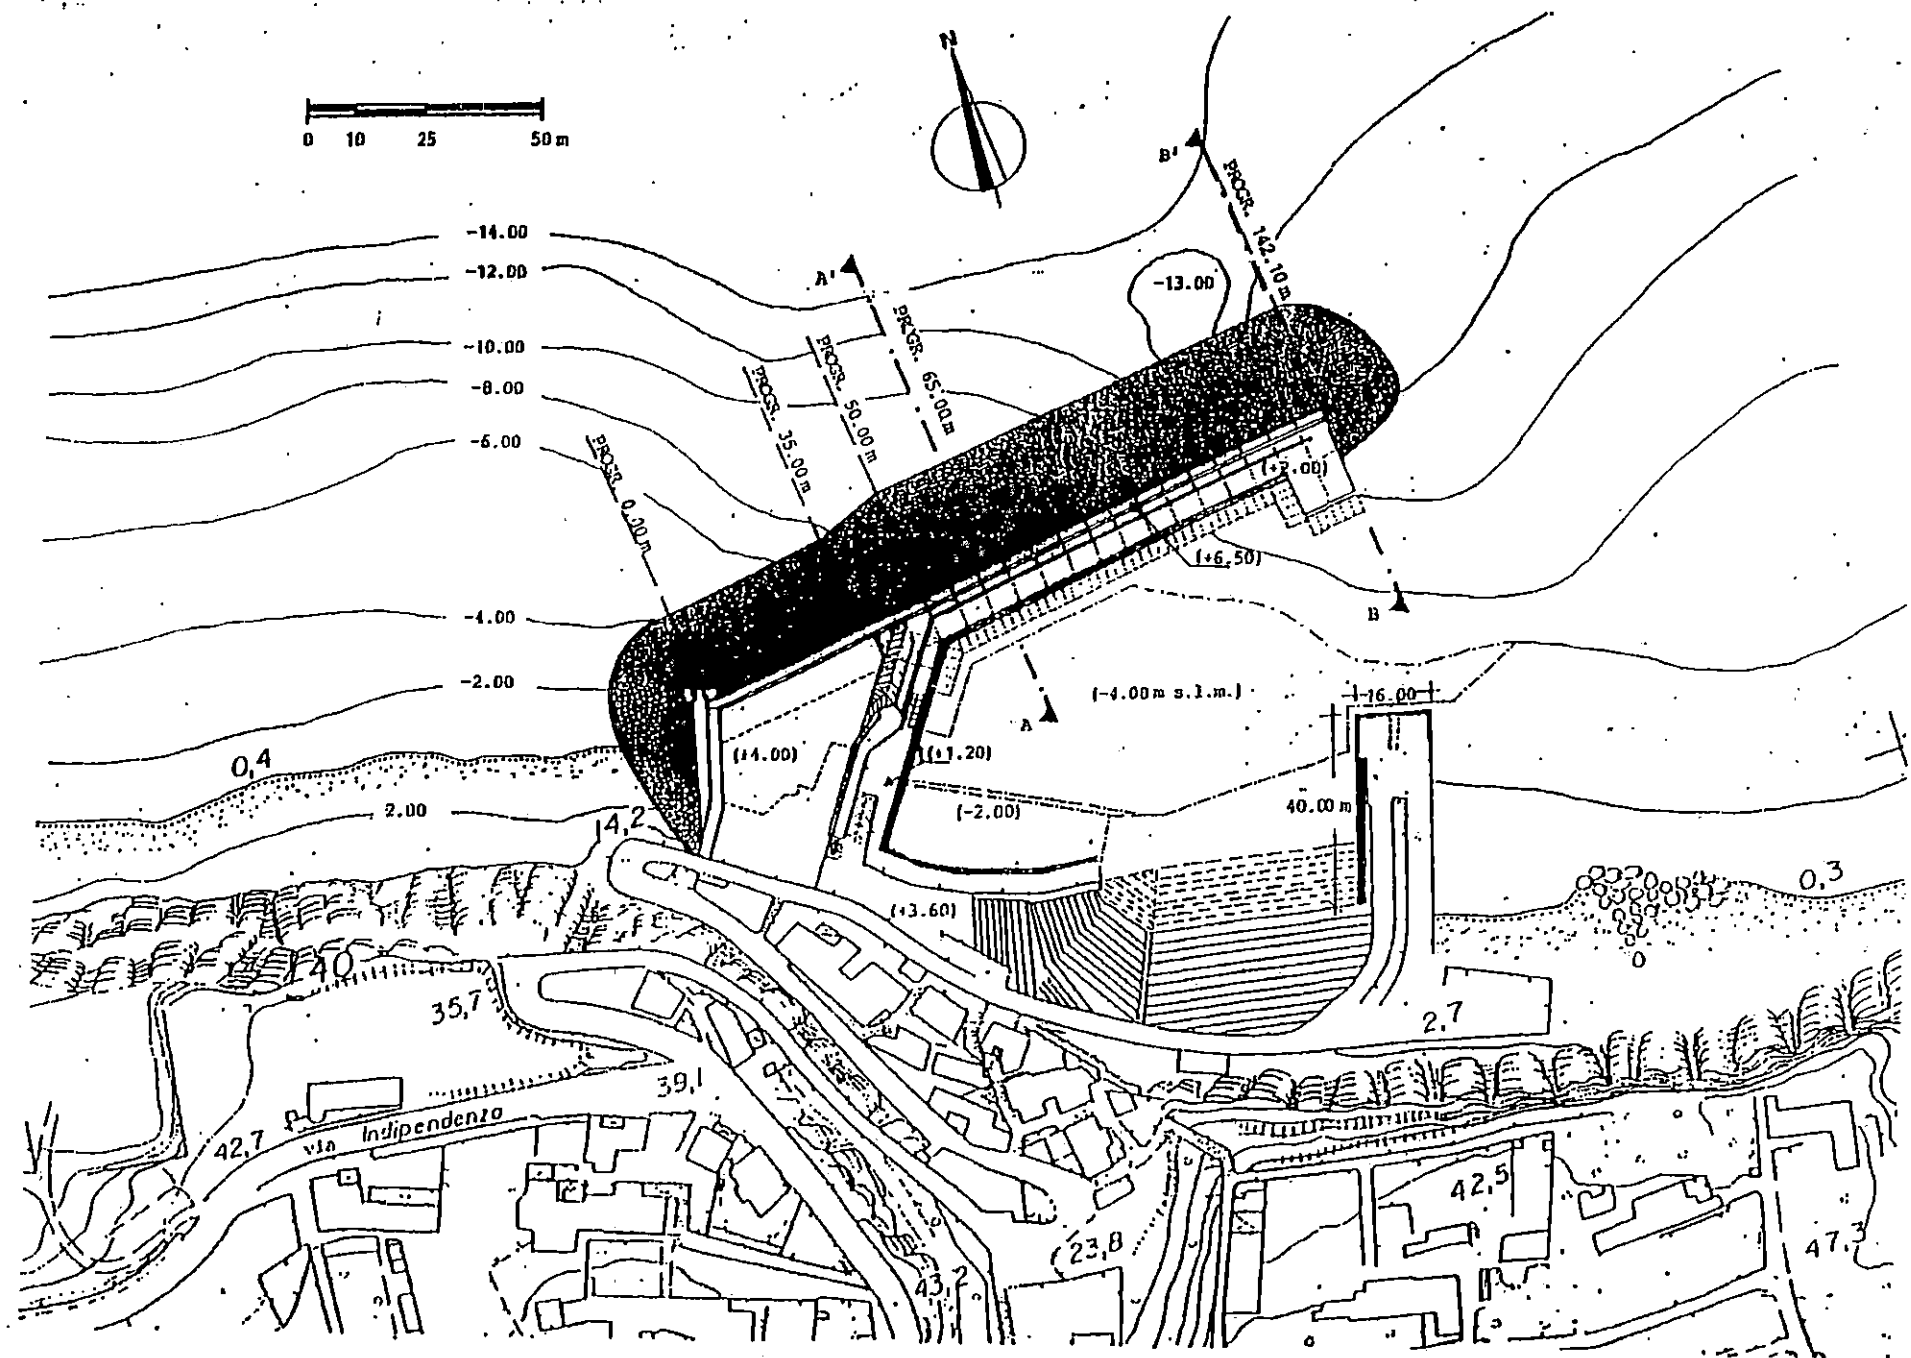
PLANIMETRIA DELL'OPERA FORANEA
